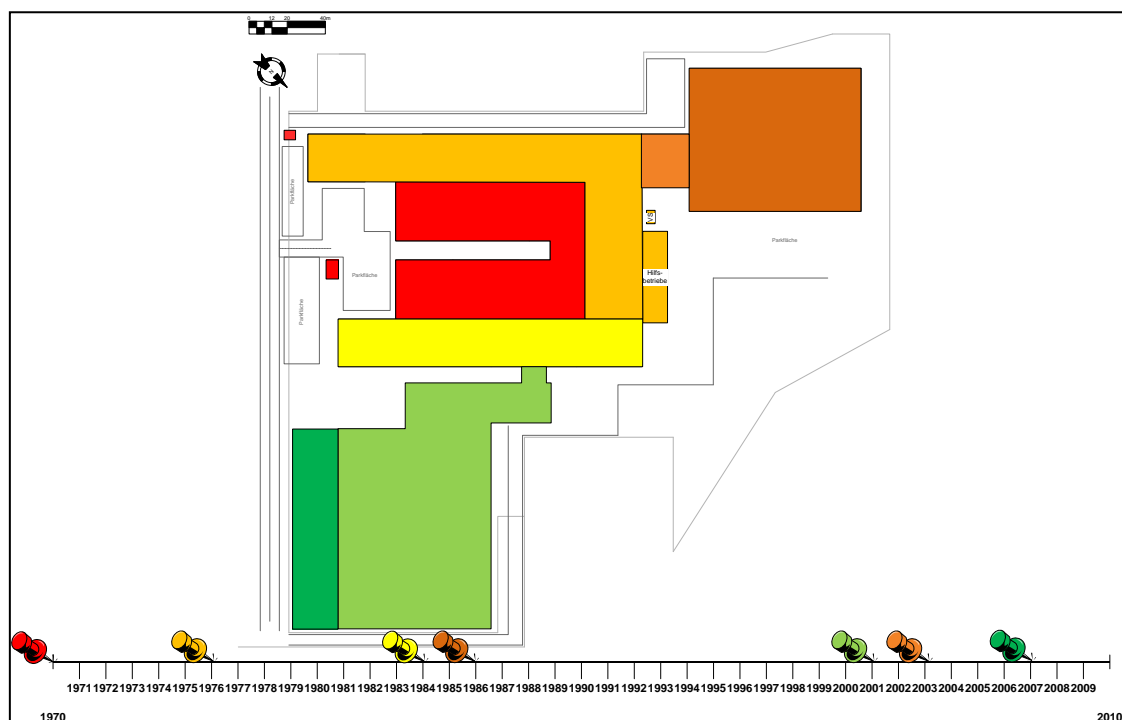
Zeitlicher Grundriss (erstellt aus diversen firmeninternen Dokumenten)
